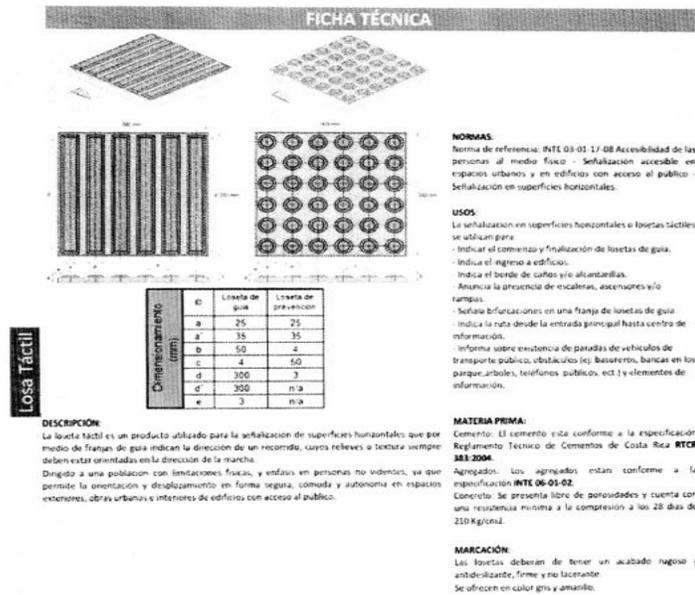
Detalle ficha técnica loseta táctil. (La imagen no es original)
